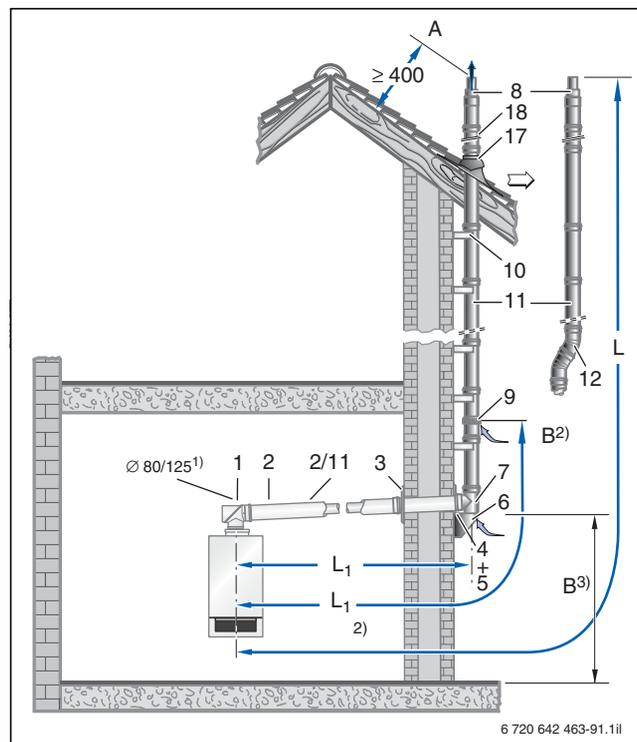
Montagevariante mit dem Bausatz GAF-K (Maße in mm)
